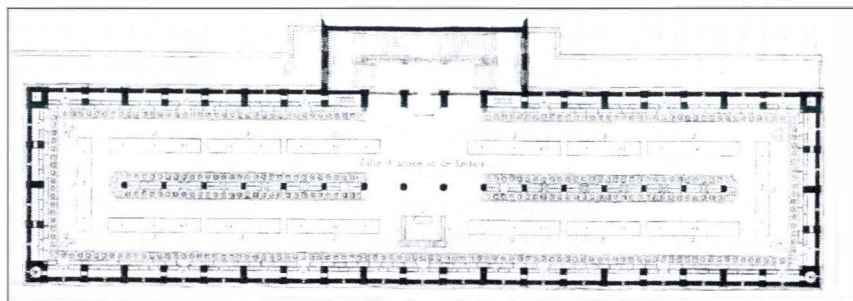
Biblioteca de Santa Genoveva, planta
